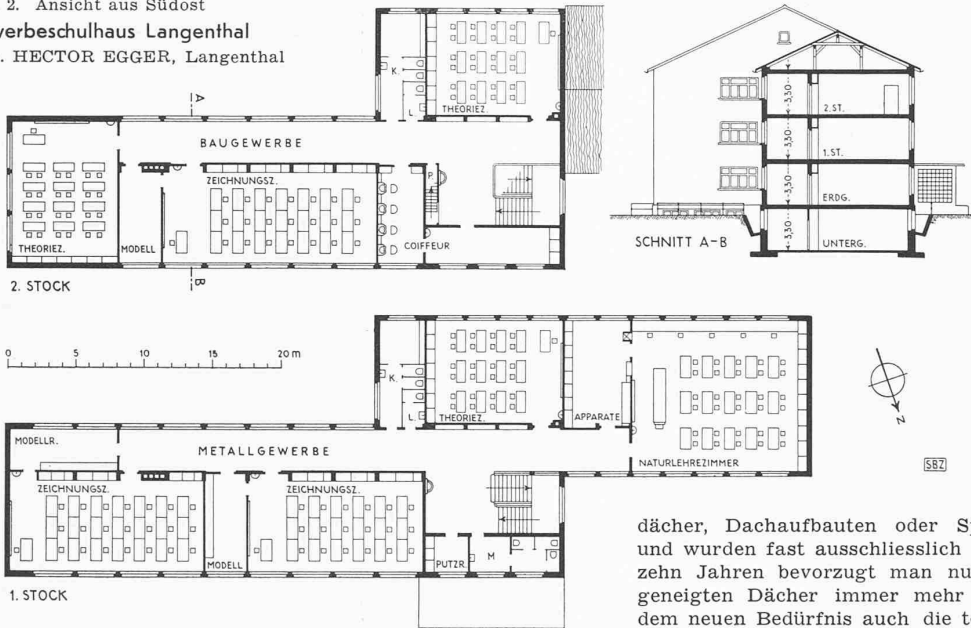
bis 5. Grundrisse und Schnitt A-B. — Masstab 1:500
